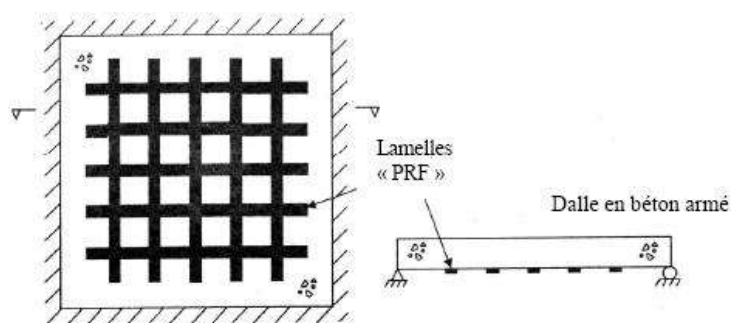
Renforcement d'une dalle (deux directions) [48].
